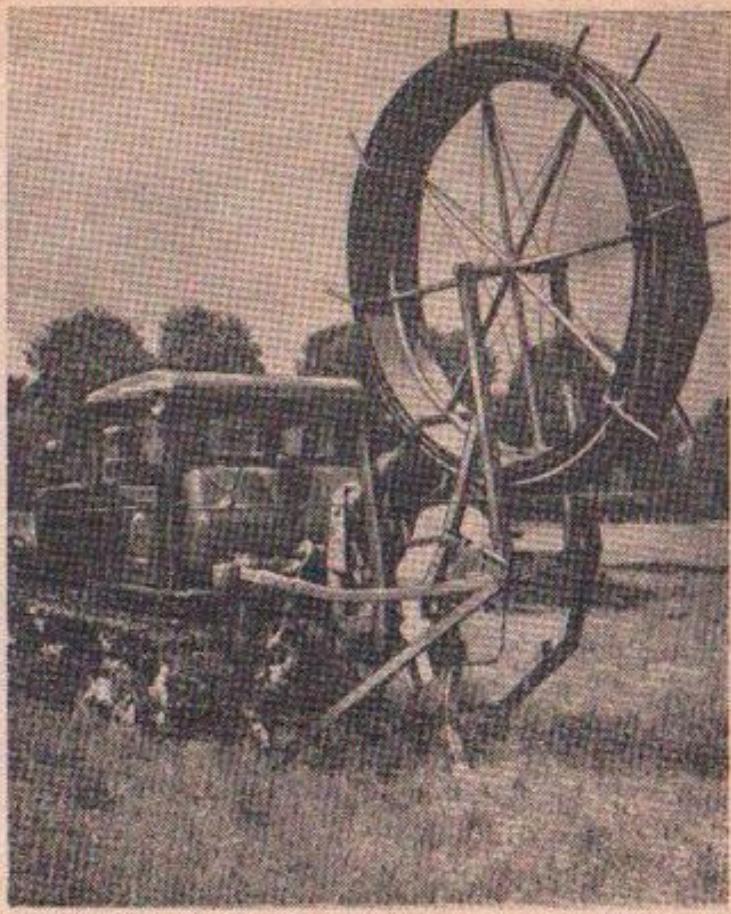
Укладка пластмассового бестраншного дренажа с оберткой дрены стекловолокном.
